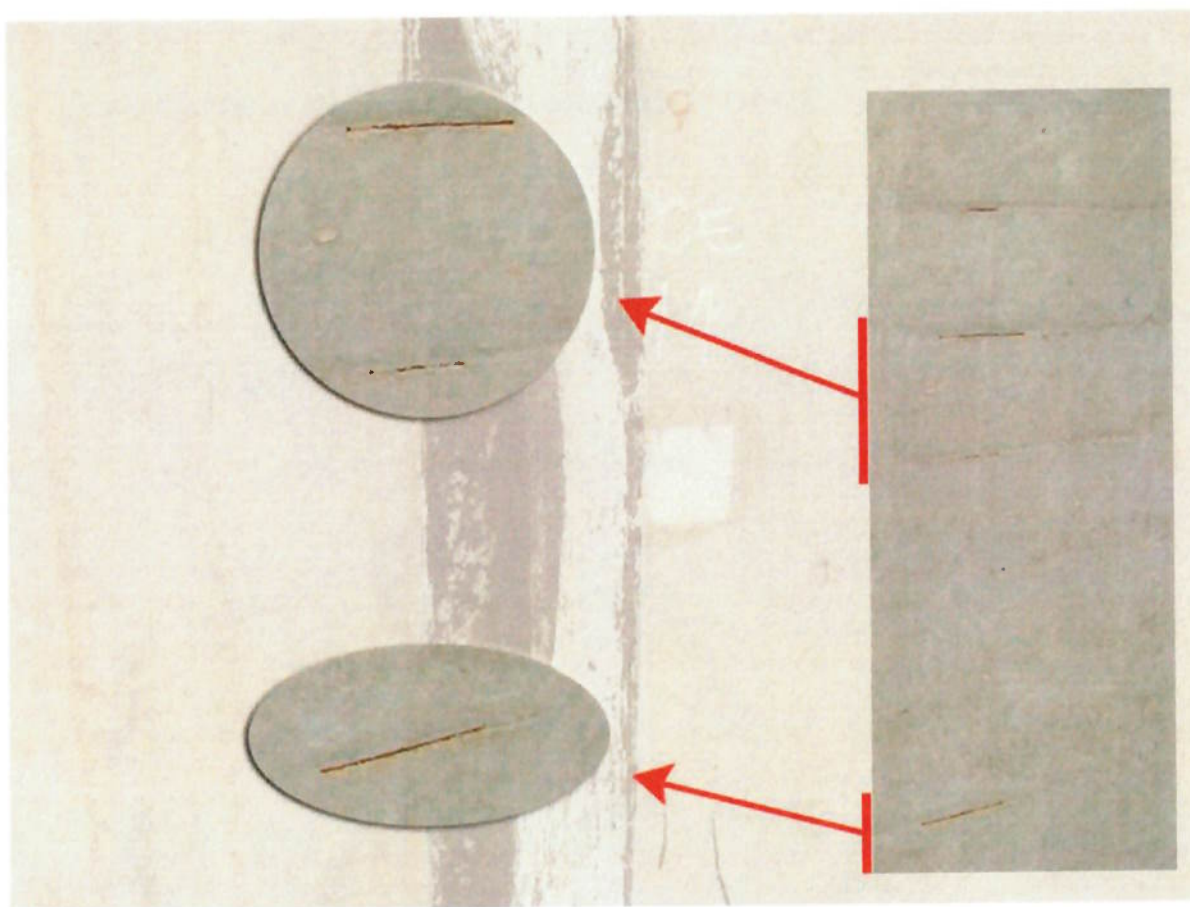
Armadura exposta em pré-moldado. Detalhe para o cobrimento insuficiente.
